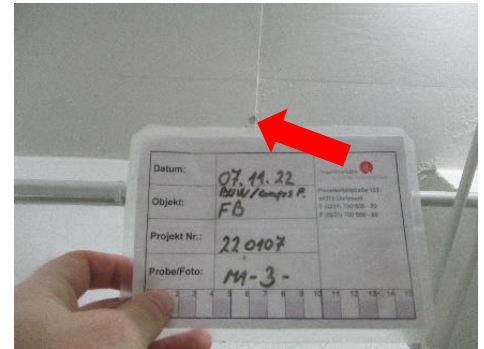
asbesthaltiger Feinputz; hier: auf Decke, Gebäude FB, EG, Flur 15, Quelle: BUW1, Seite III-1
